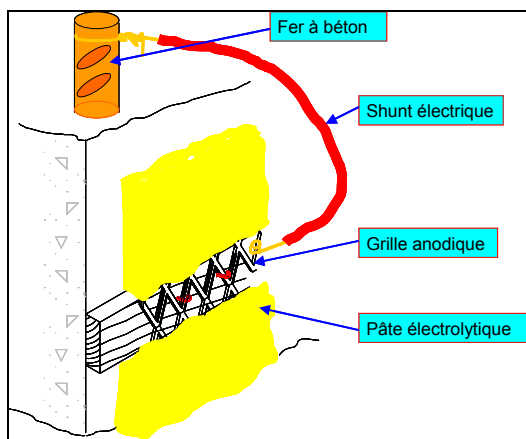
Schéma du principe d'installation du traitement Regebeton pâte.
